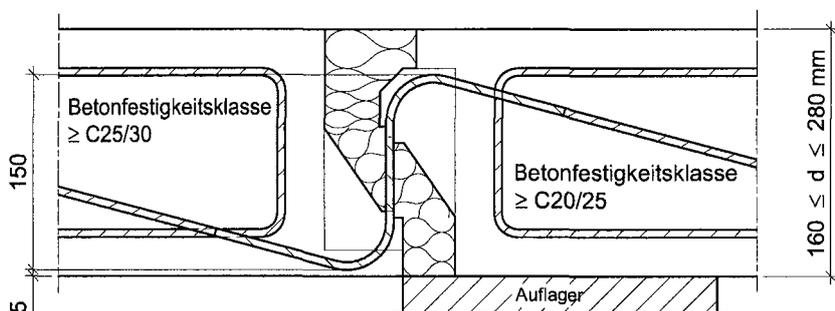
Beispiel Schöck Isokorb Typ V mit Aufhängebewehrung nach Abschn. 3.2.1
